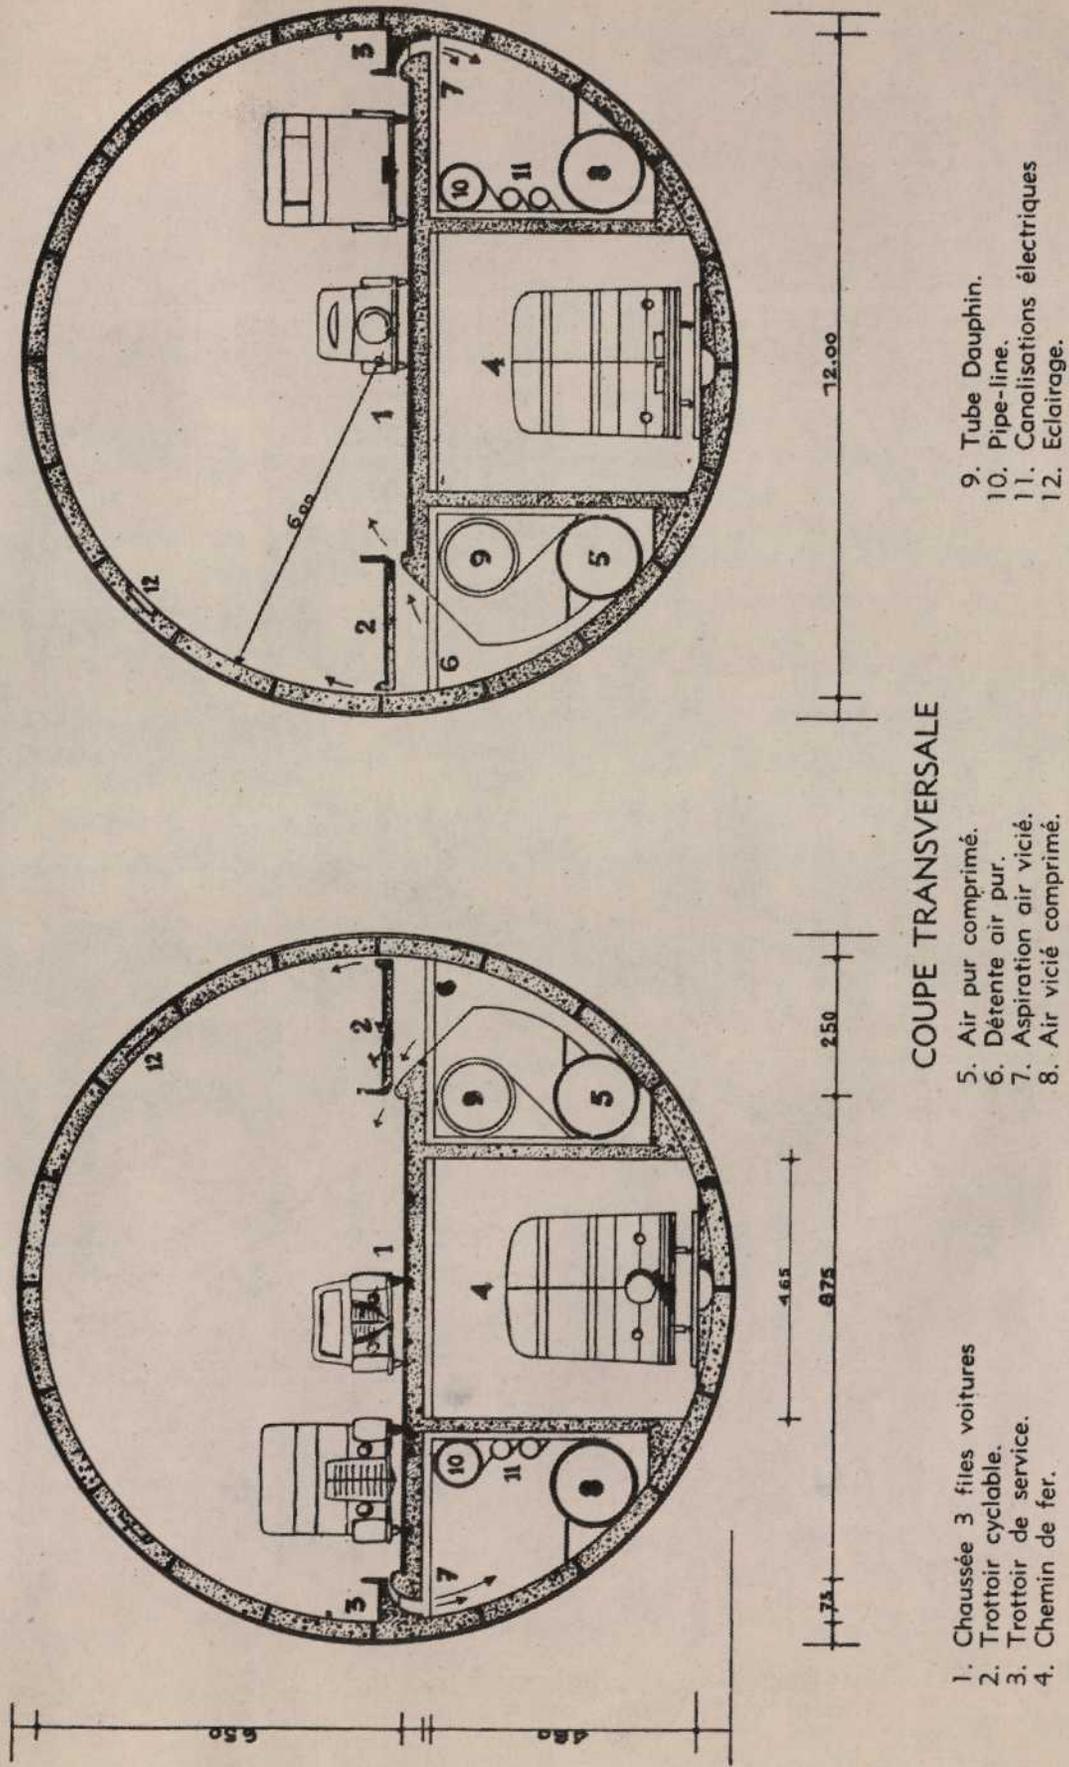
Coupe du demi tunnel routier Basdevant 1937
